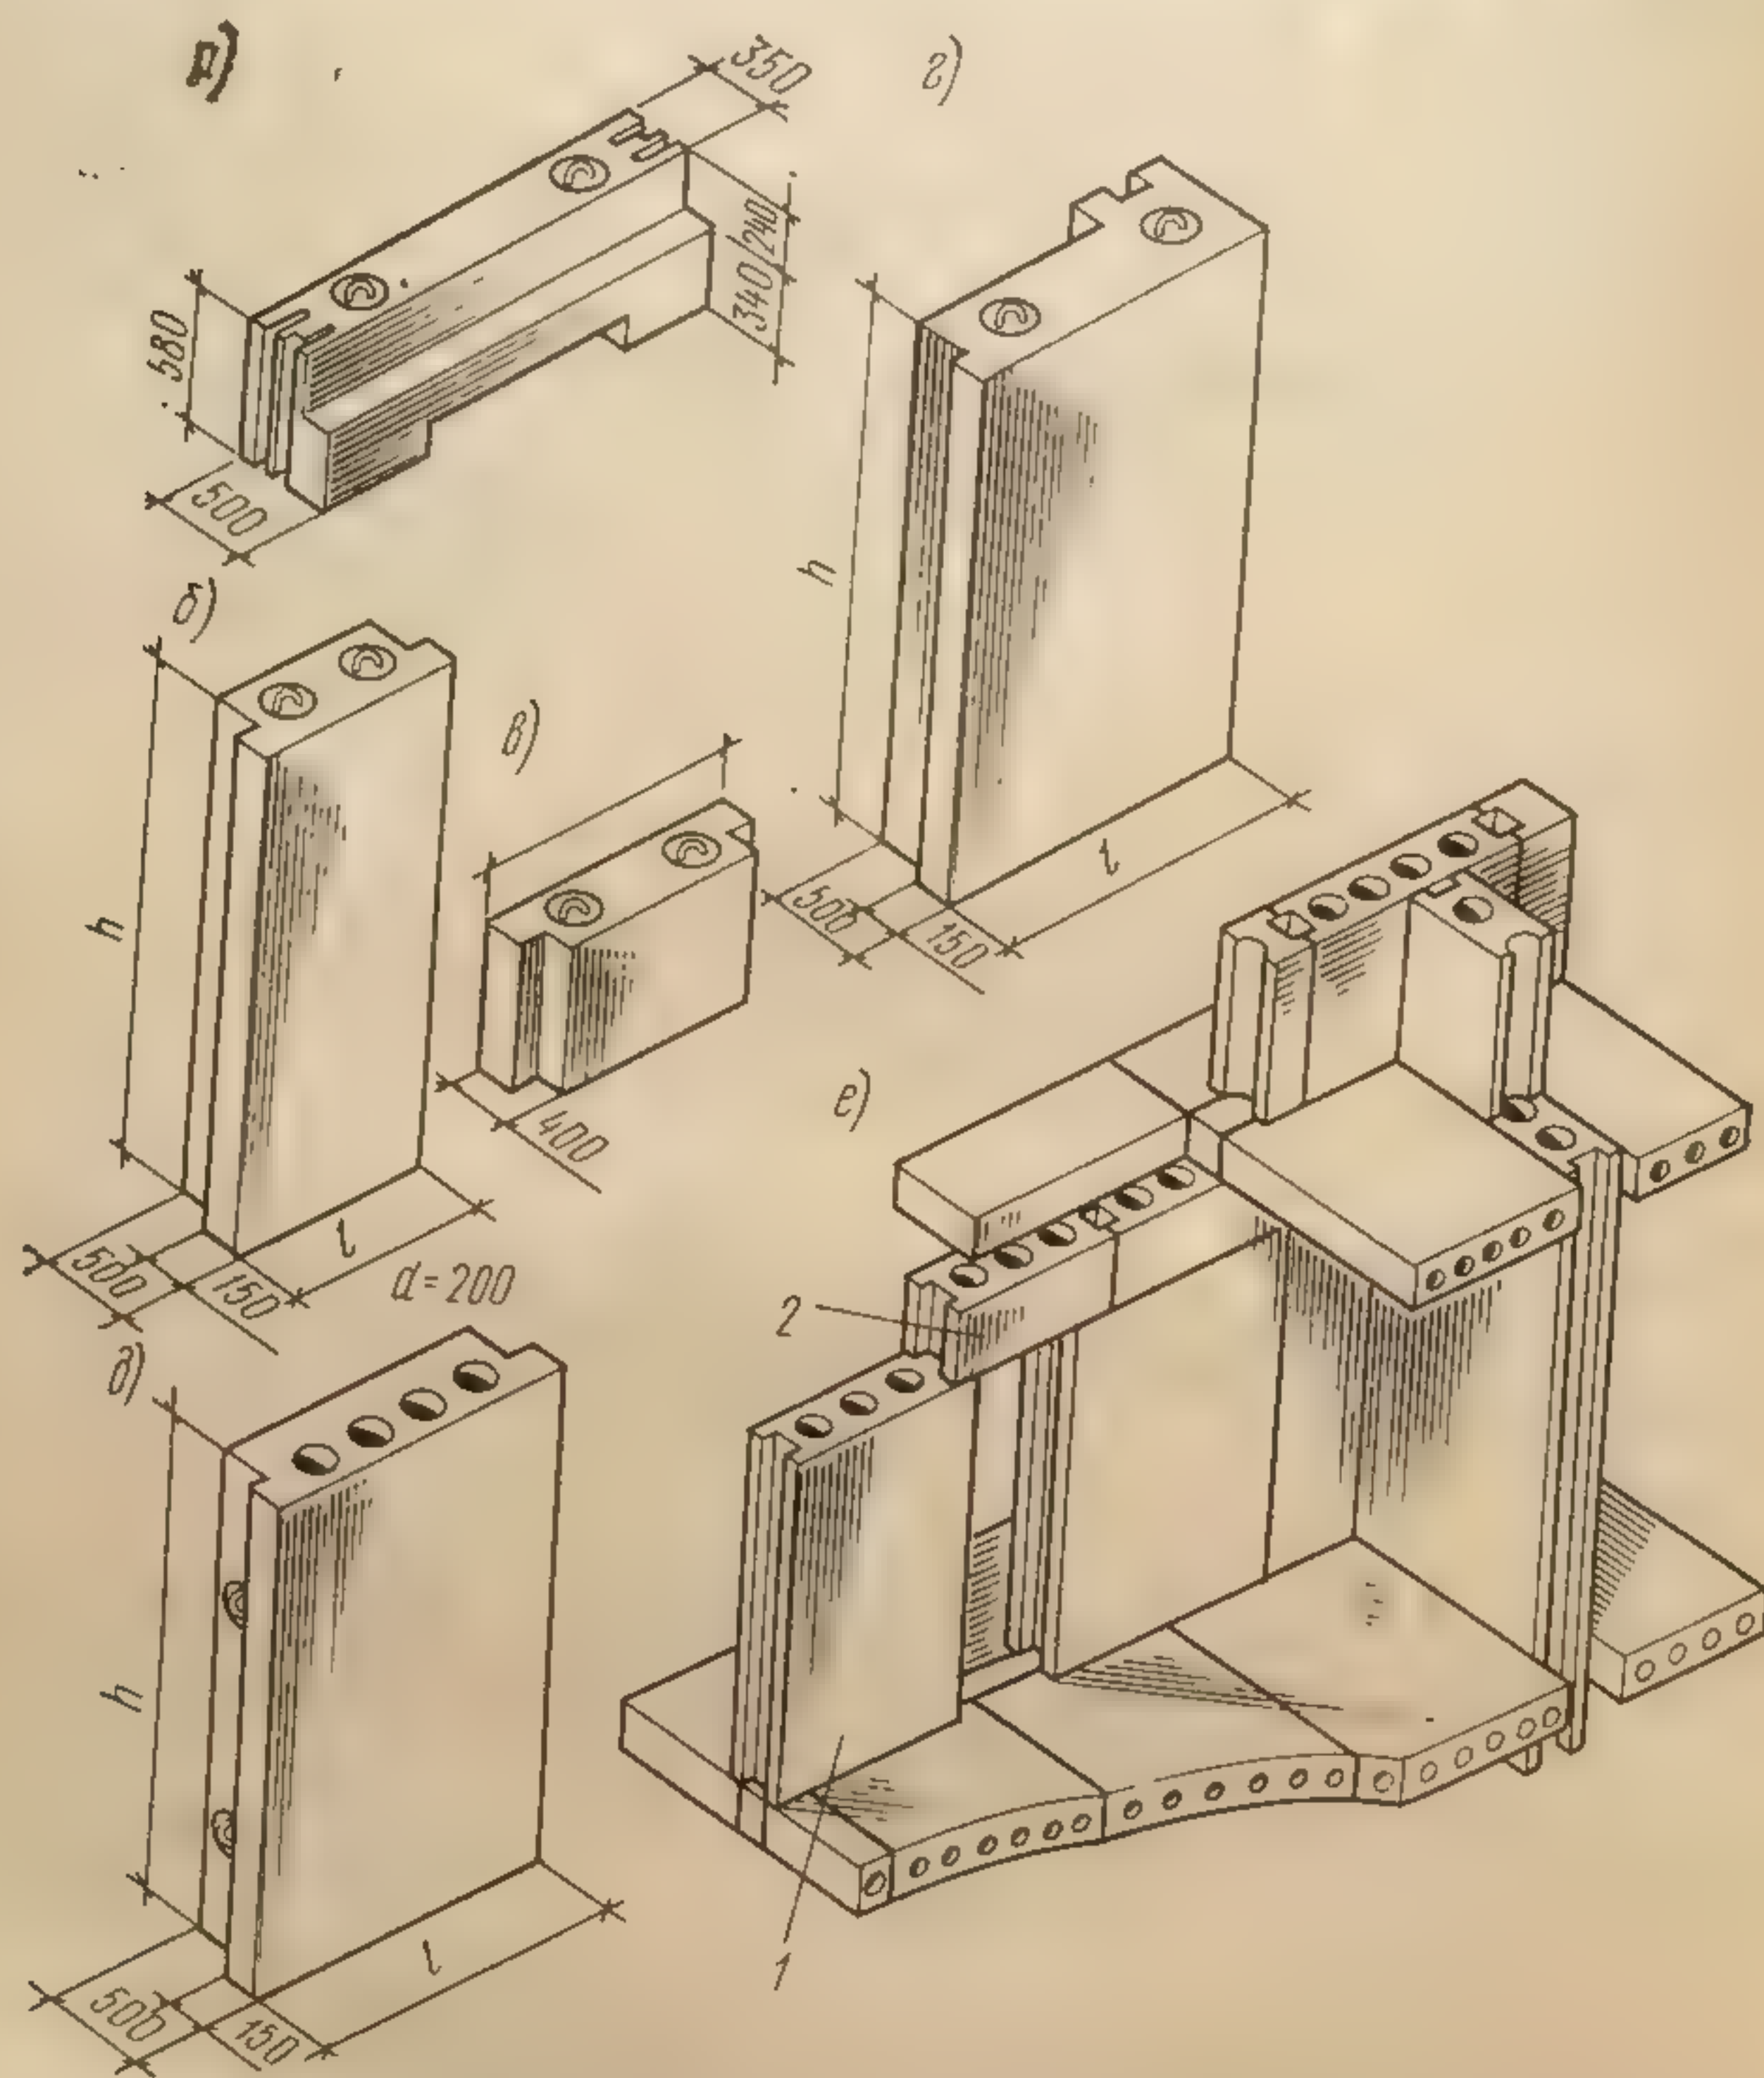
Основные типы крупных блоков стен жилых зданий:
